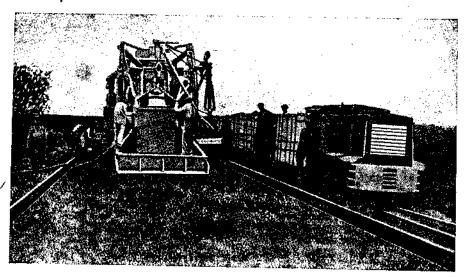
Подача материалов к бетономешалке поездом вагонеток, с выгрузкой вагонеток в ковш поворотным краном бетономещалки.
